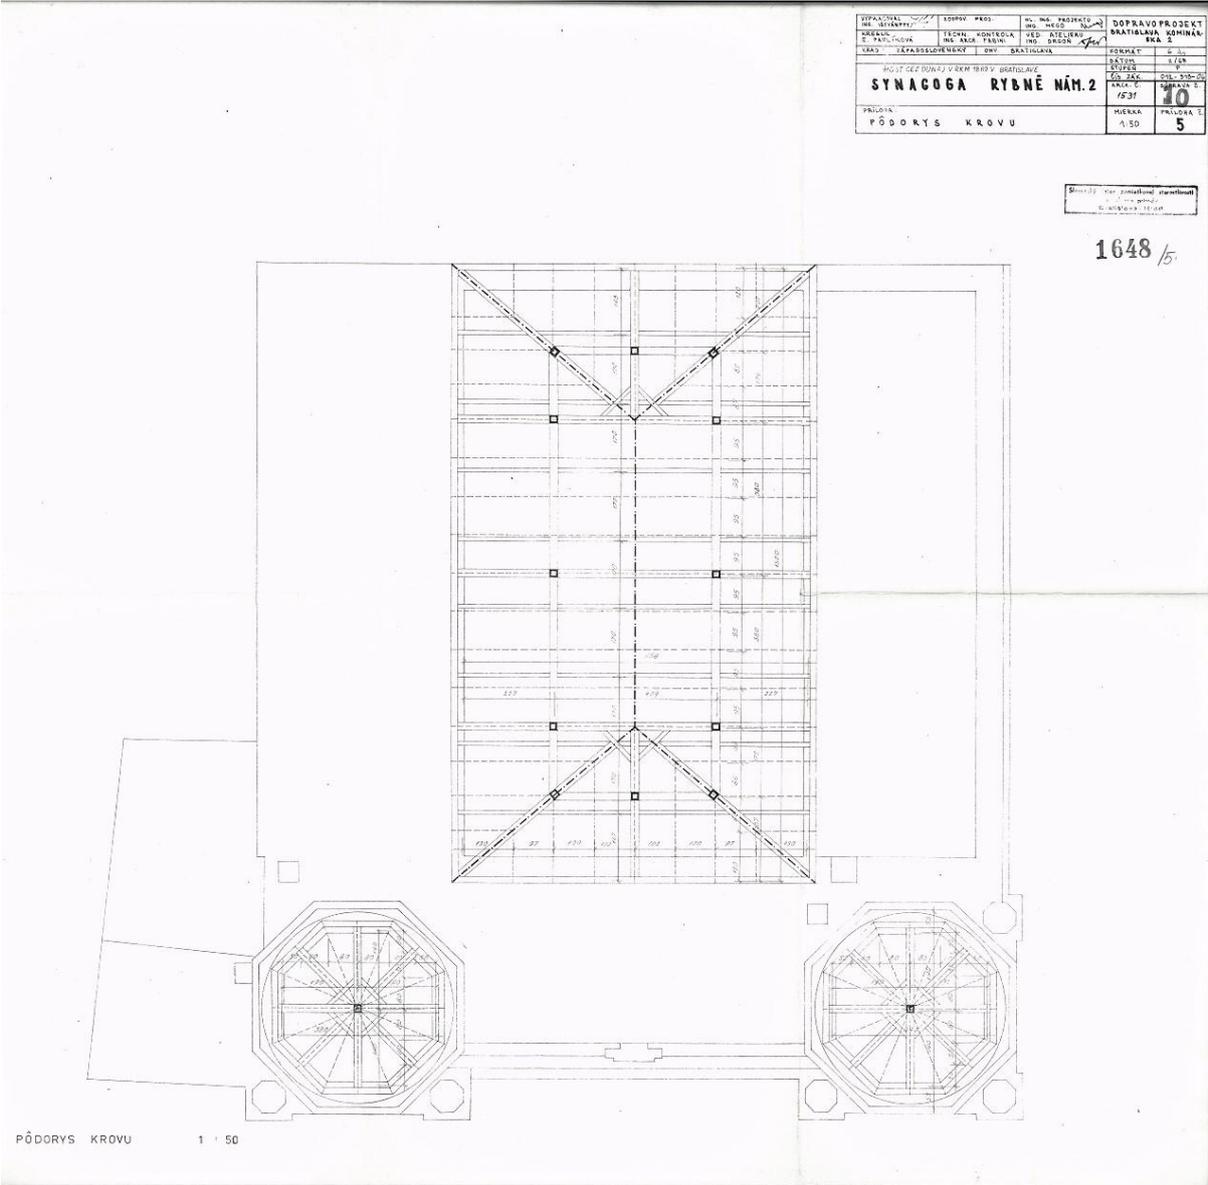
Grundriss Dachstuhl M 1:50, 1967
